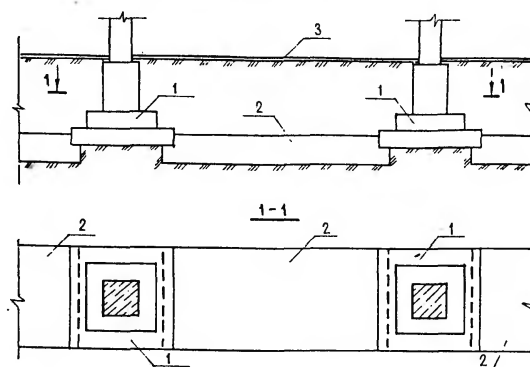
Устройство перемычек снизу опорных плит фундаментов
